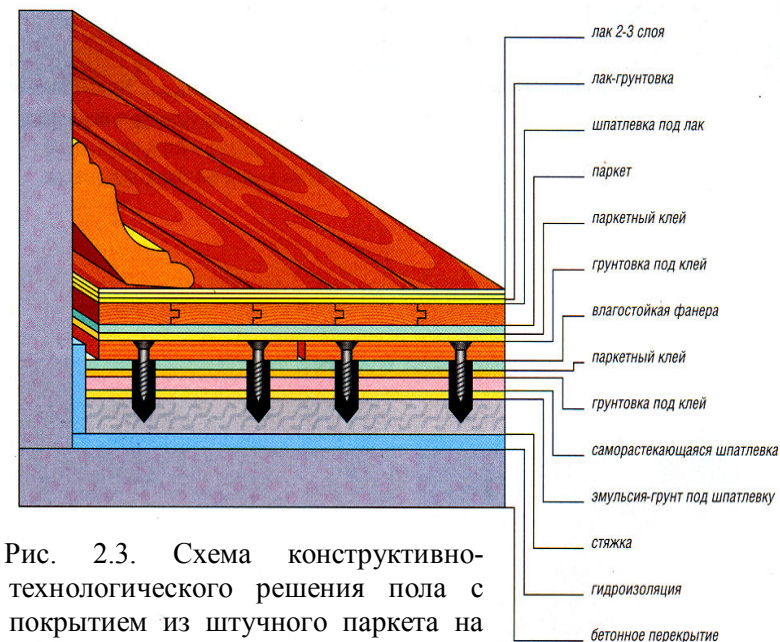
Схема конструктивно-технологического решения пола с покрытием из штучного паркета на бетонном перекрытии (со стяжкой)
